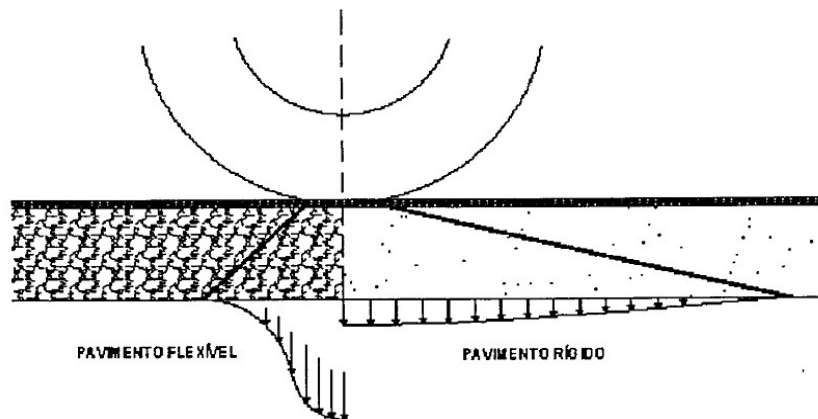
Configuração da distribuição de tensões verticais no solo de fundação de um pavimento flexível e rígido (Fonte: Braga, 2018)
